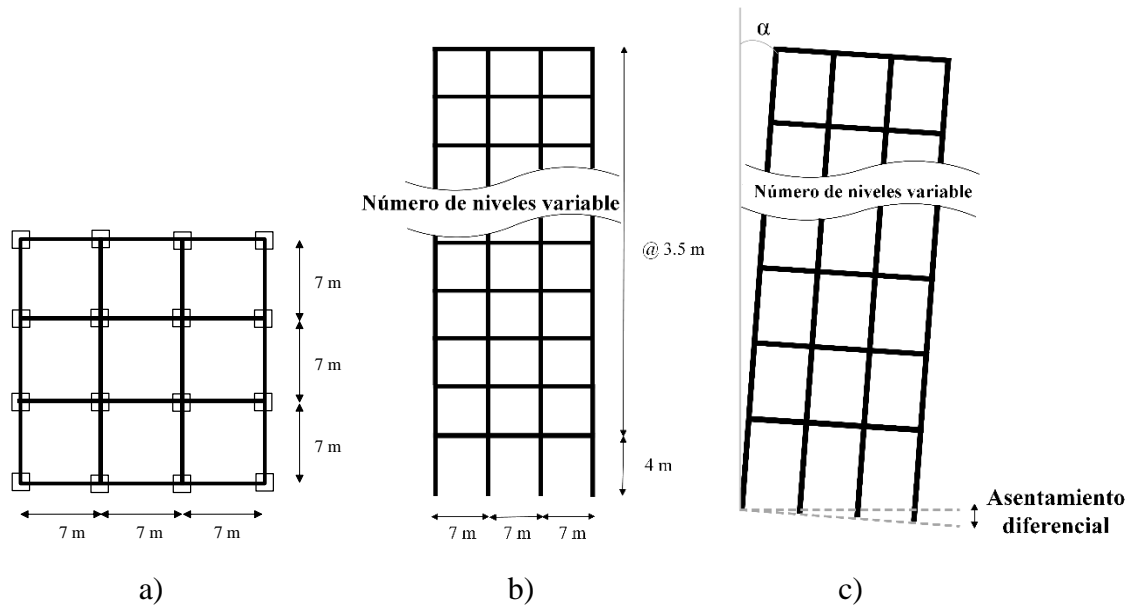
a) Planta, b) Elevación, y c) Caracterización de la asimetría en fluencia de los edificios.
